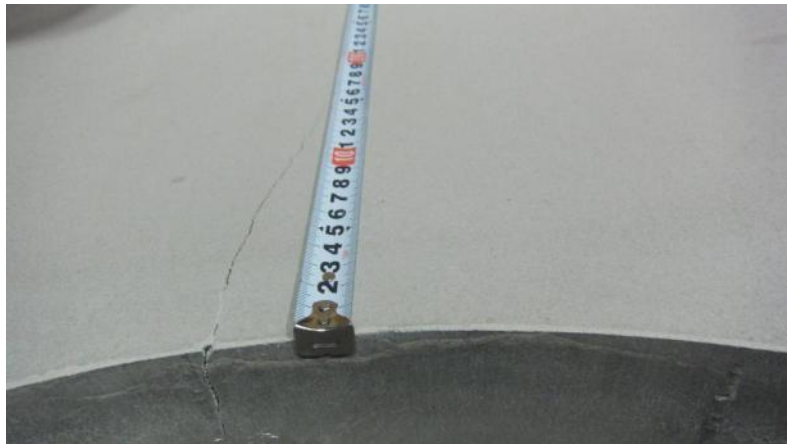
緩衝材（ID-92）のひび割れ（例）
